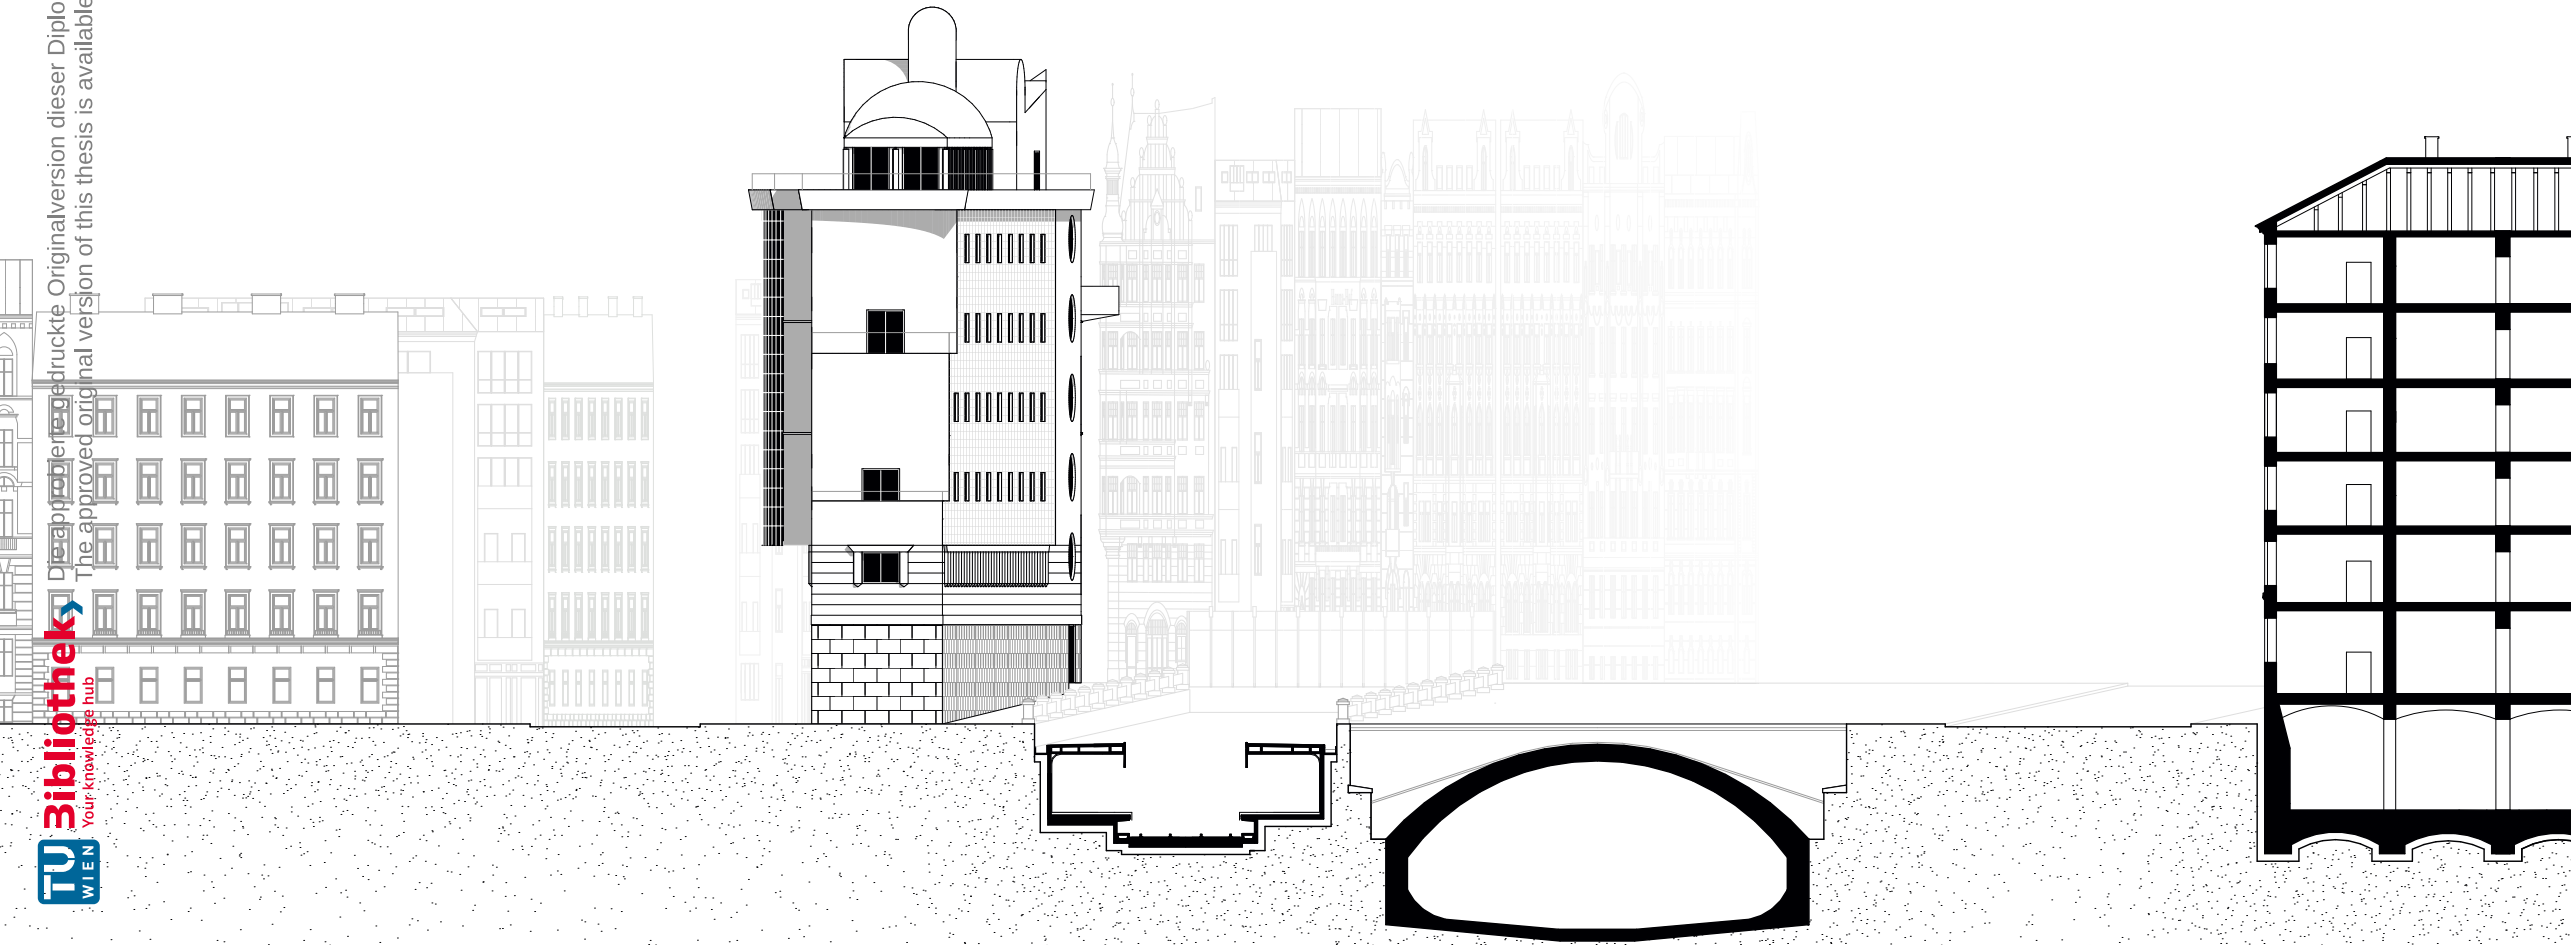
/ Ansicht Ost M 1:400 (Plan erstellt von PB) <
